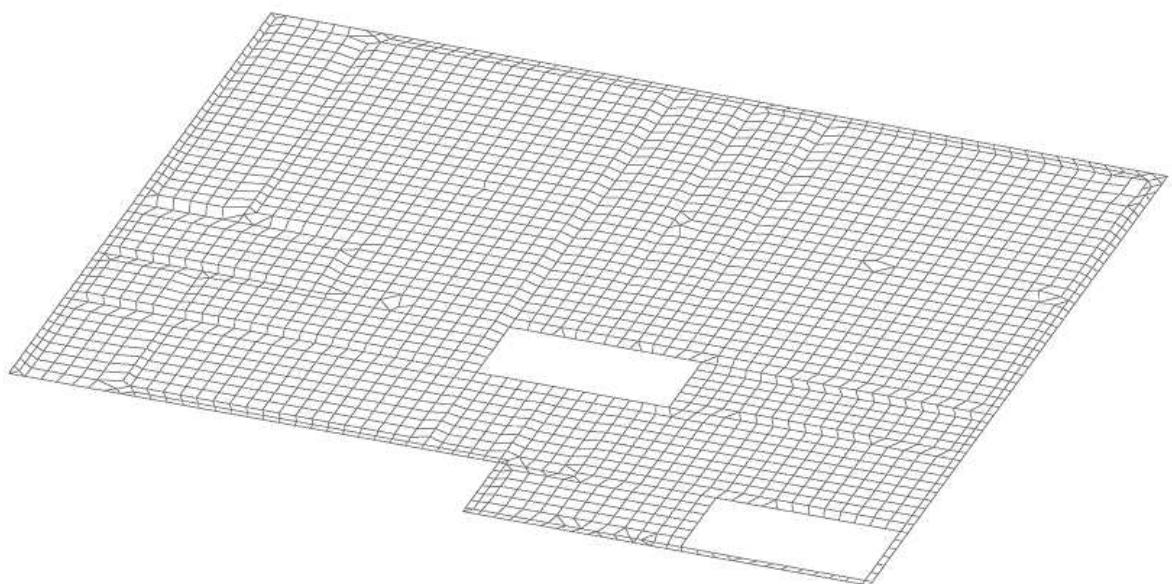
Фрагментированный участок (перекрытие на отметке 0,000)
